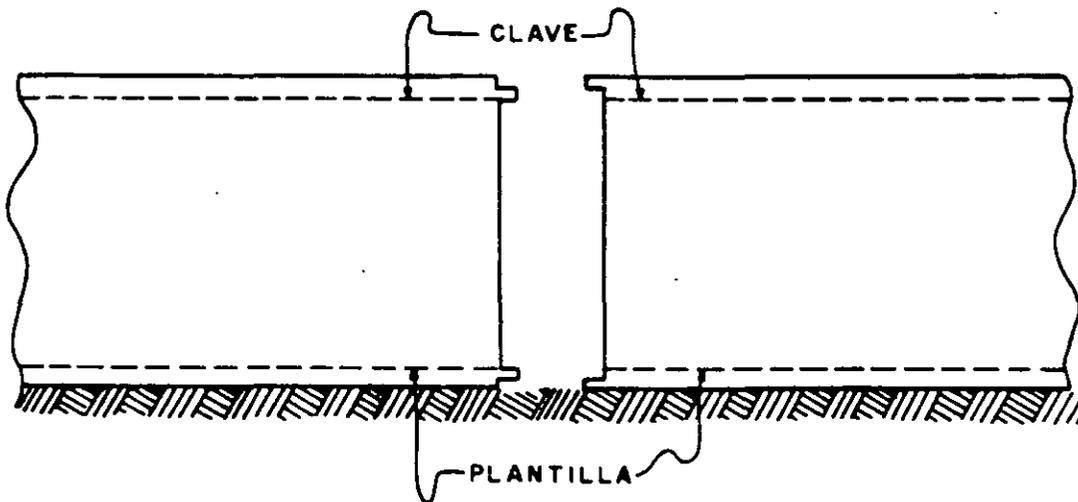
UNION EN TUBERIA DE CONCRETO REFORZADO
